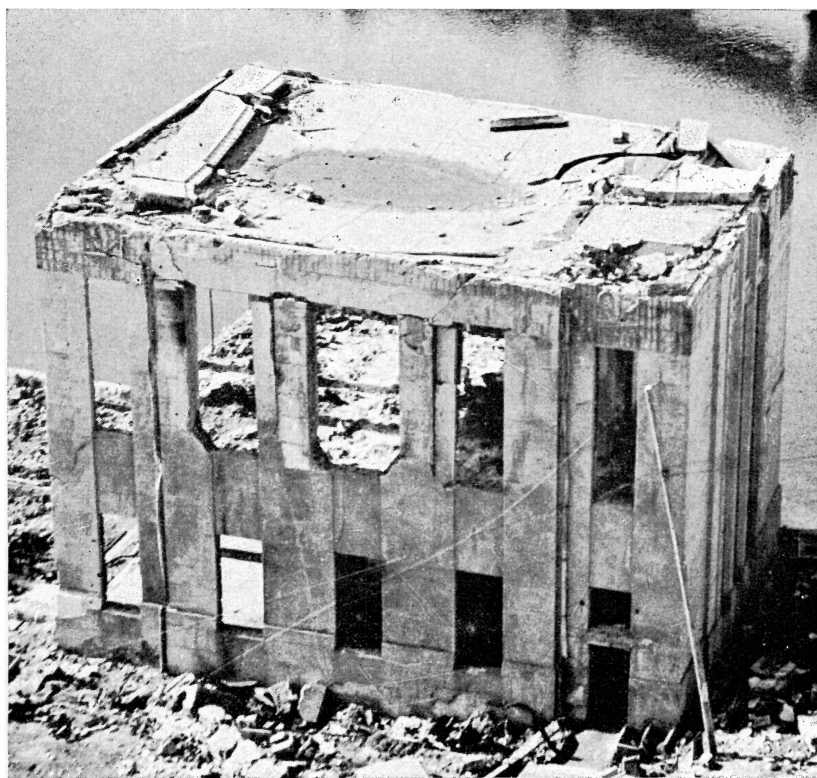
Eingedrücktes Dach eines Stahlbetonbauwerks 160 m vom Nullpunkt in Hiroshima
